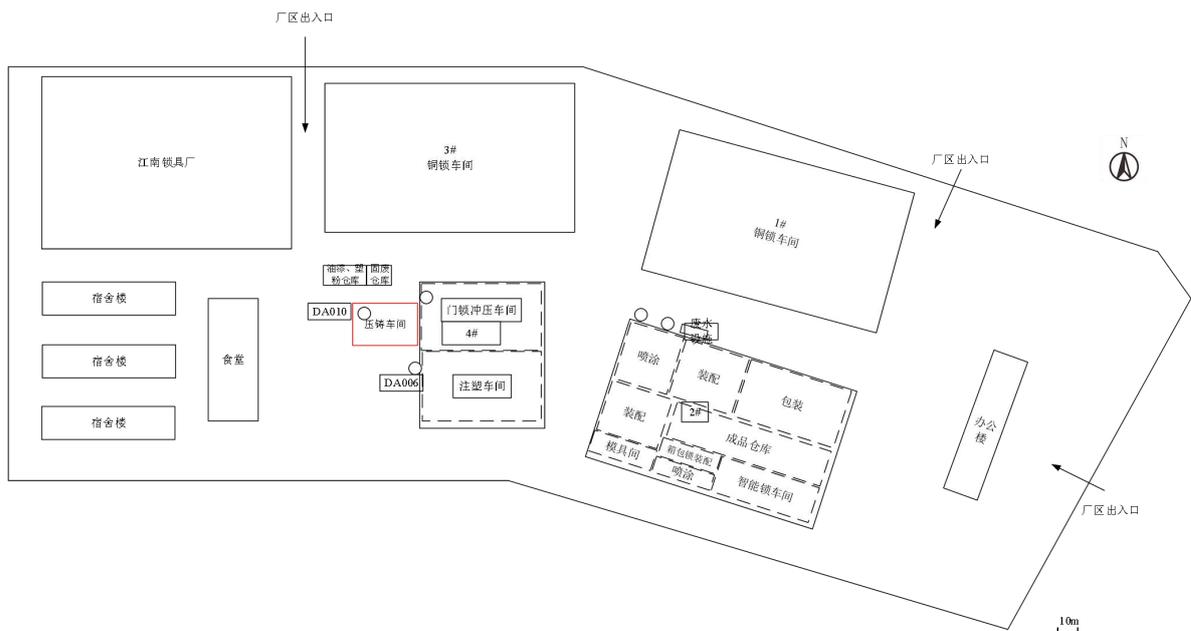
项目厂区平面布置图（红色框线内为本次新增车间）
